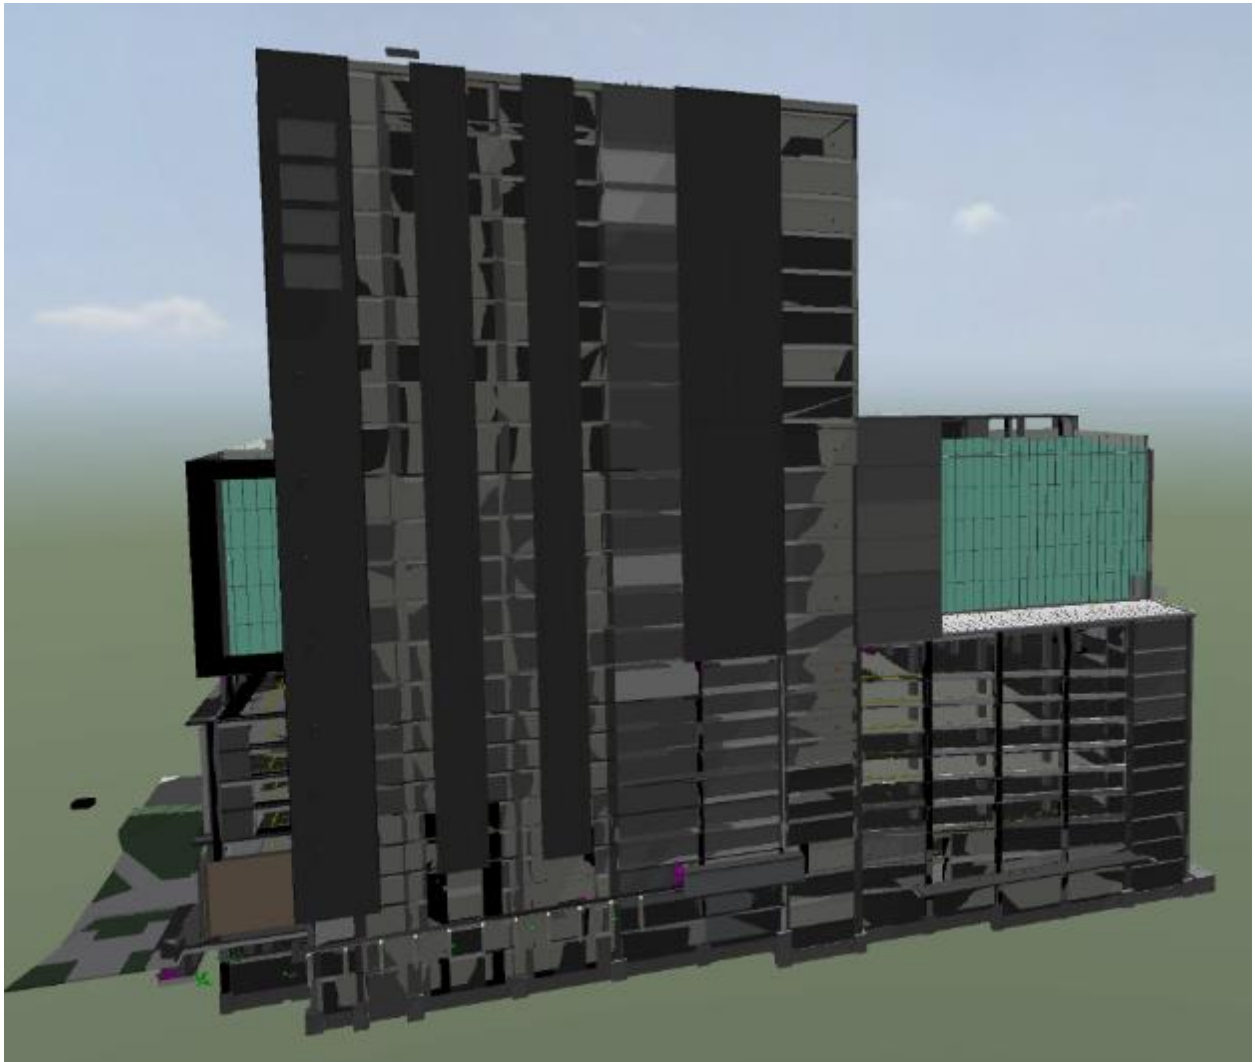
Fachada oeste. Fuente: Extralum (2019)
